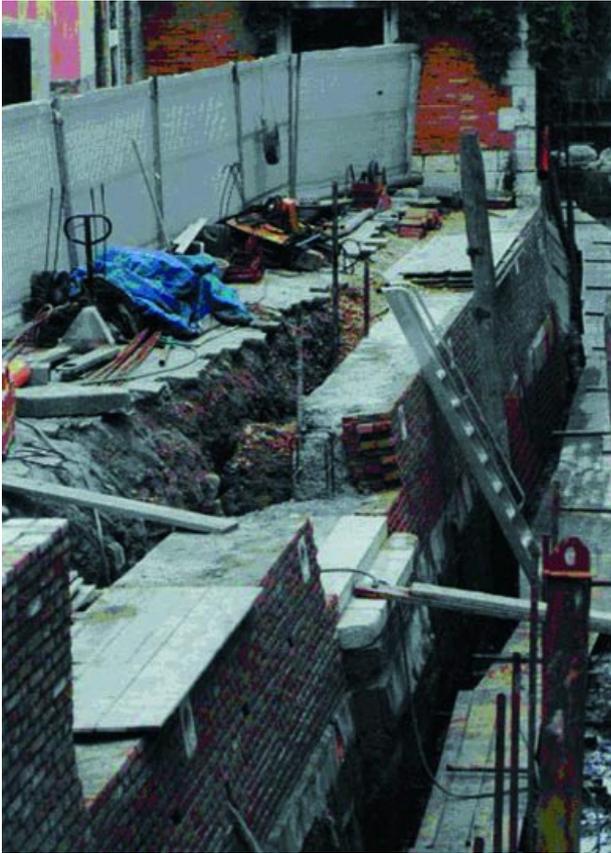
Intervento di ricostruzione di un muro di sponda
